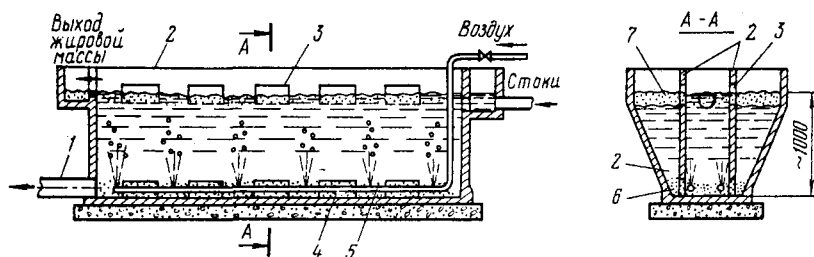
Схема призматической жироловки с продувкой воздухом:
